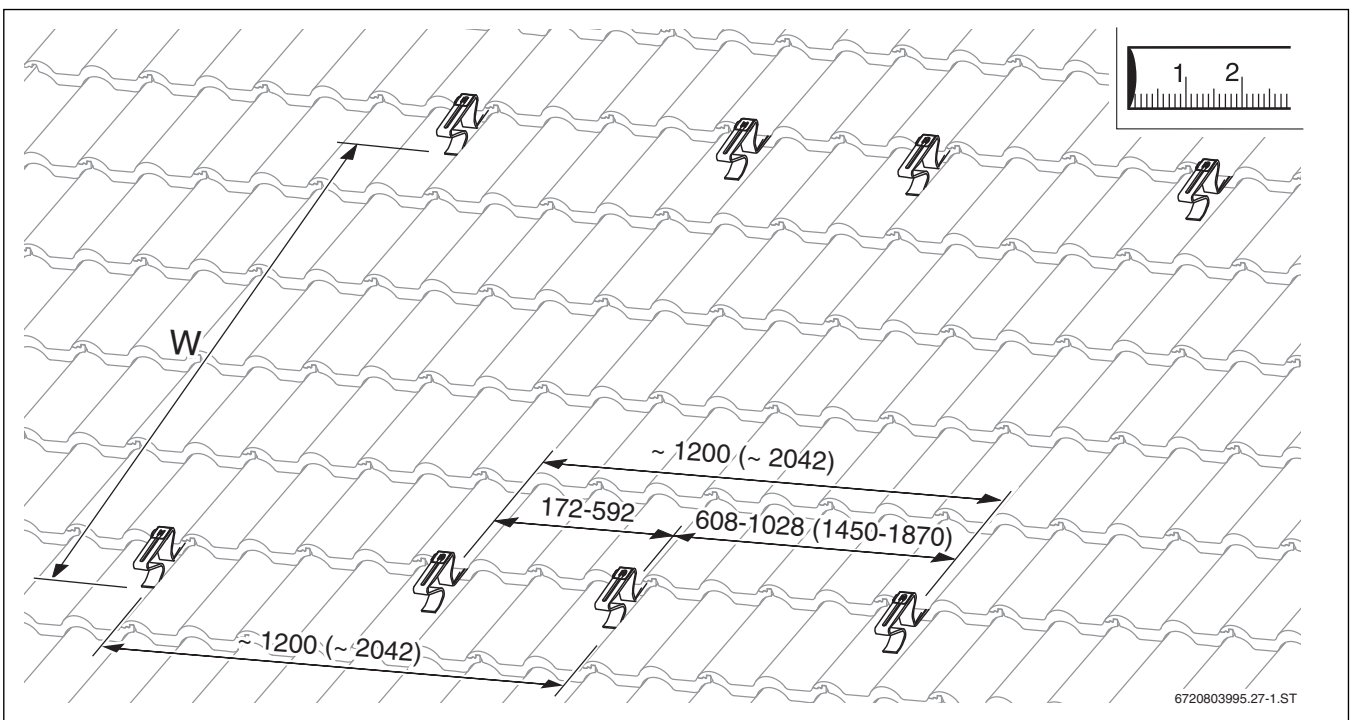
Dachhaken für zwei Kollektoren (Maße in Klammern beziehen sich auf waagerechte Kollektoren; Maße in mm)
